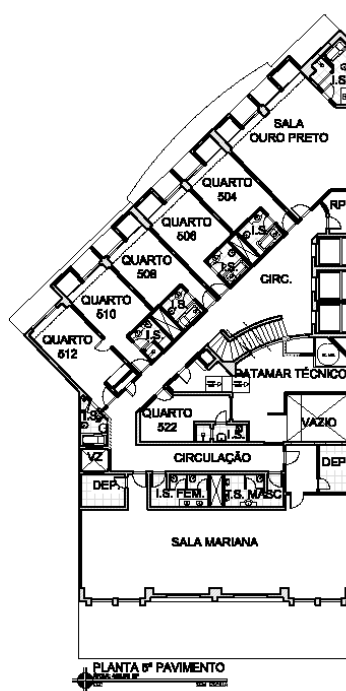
PLANTA 5º PAVIMENTO – HOTEL NORMANDY – ELABORADO PELA AUTORA – 09/2011.
